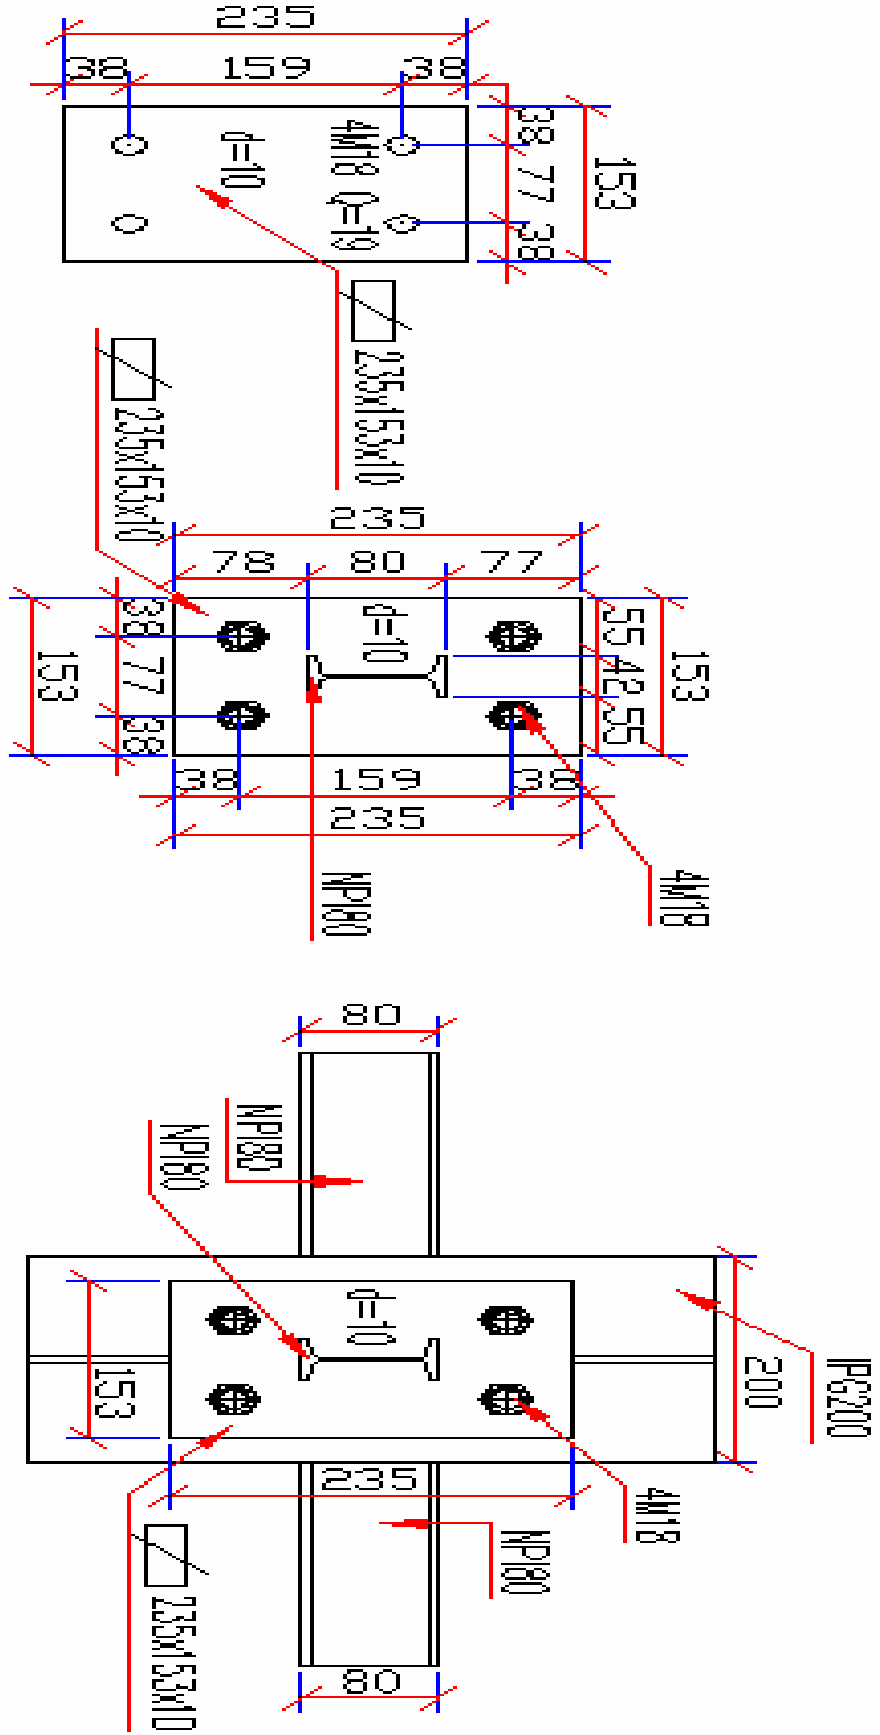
Kolon ayağı detayı ve bağlantı levhaları
